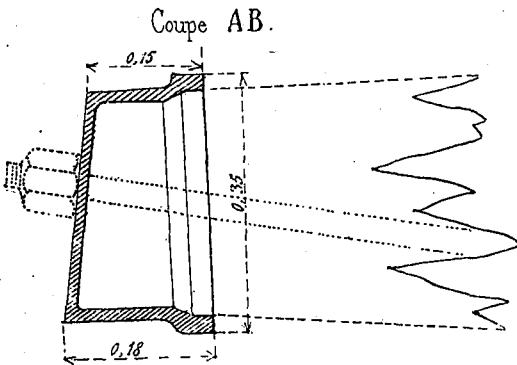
(Chapeau pour extrémités de poutres armées.)
